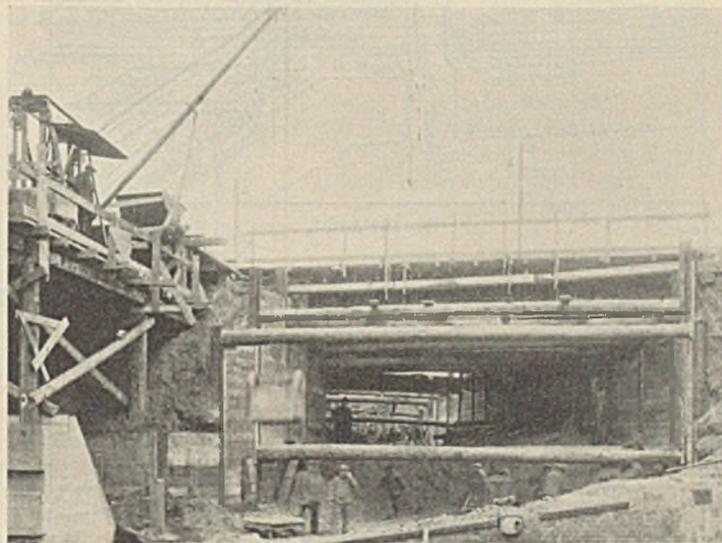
Schlitz für das östliche Widerlager von Bauwerk C. im Ausschachten begriffen.
